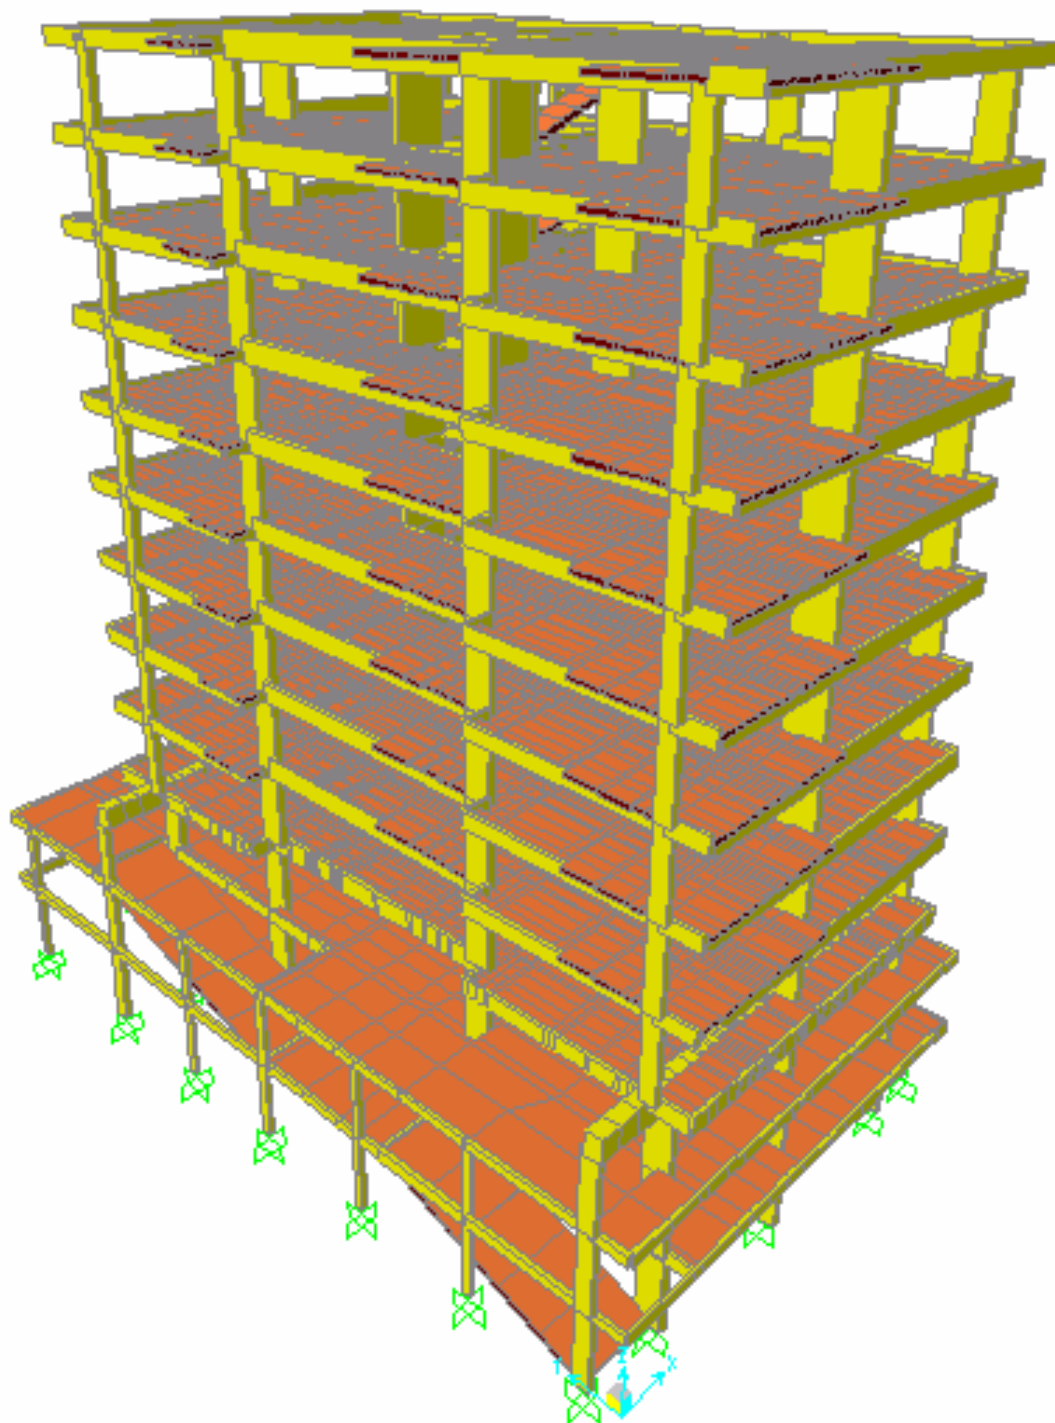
Modelo tridimensional da estrutura para a 12^a laje.
